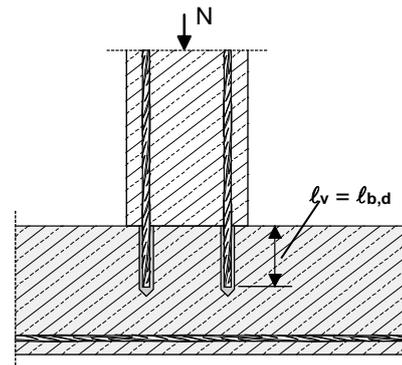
Ancrage direct d'armatures pour élément principalement en compression. Les armatures subissent une contrainte en compression.
